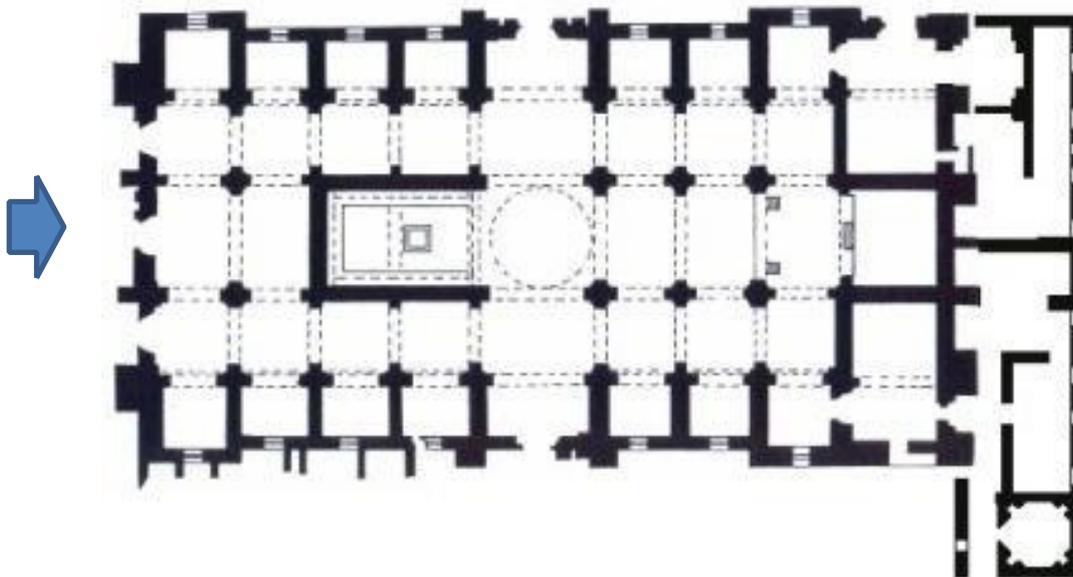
Planta Arquitectónica de Catedral de Puebla
